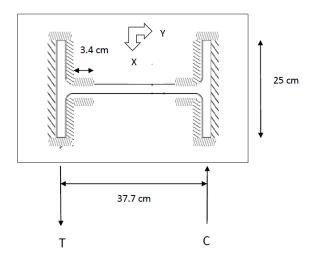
Ubicación de fuerza de tensión para la soldadura de filete entre columna y plancha Fuente: Propia
